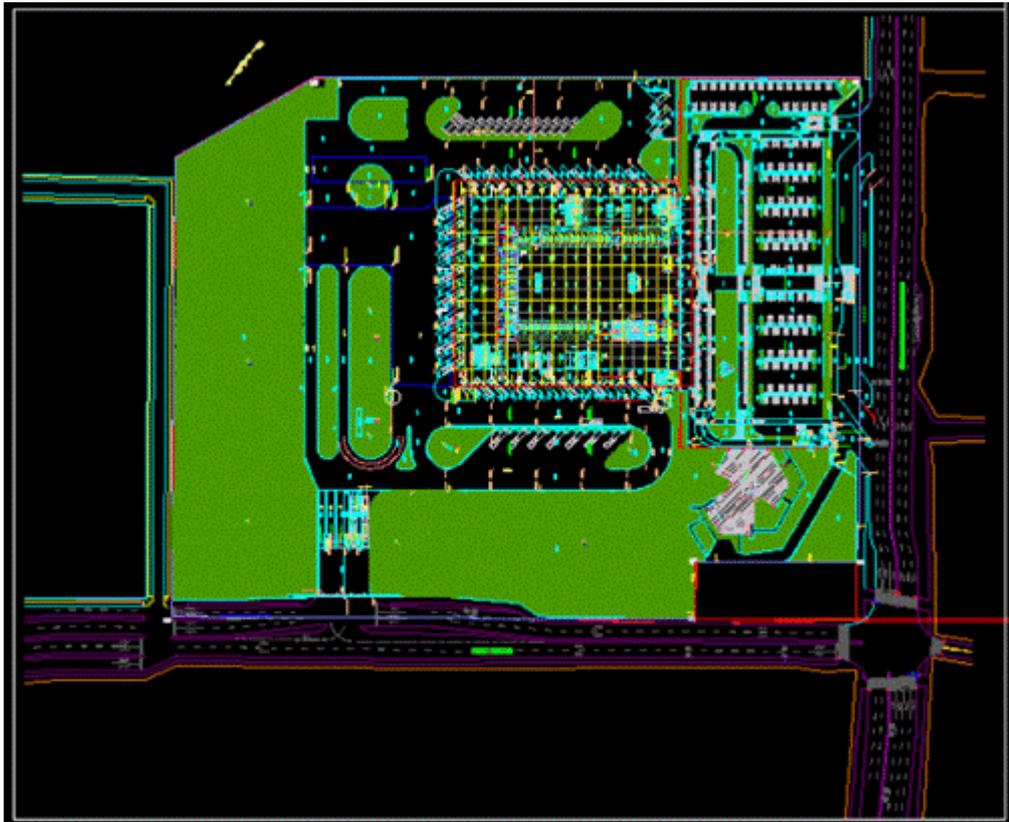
Vista en planta de la Terminal Terrestre Trujillo - Perú
